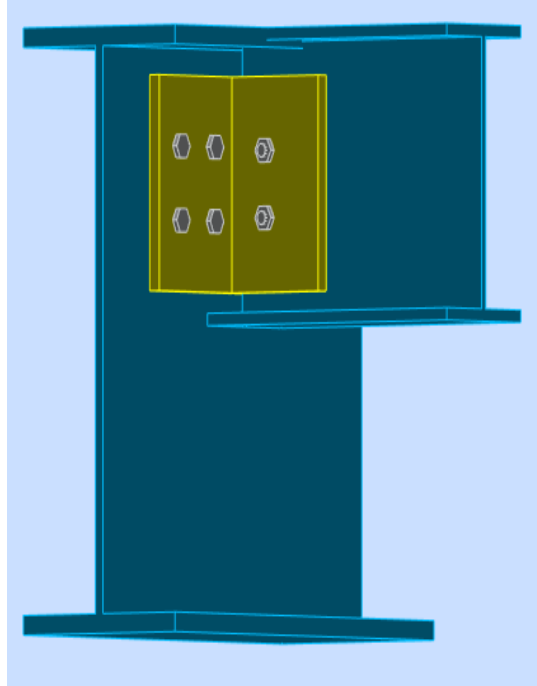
Vue 3D de l'assemblage poutre solive.
